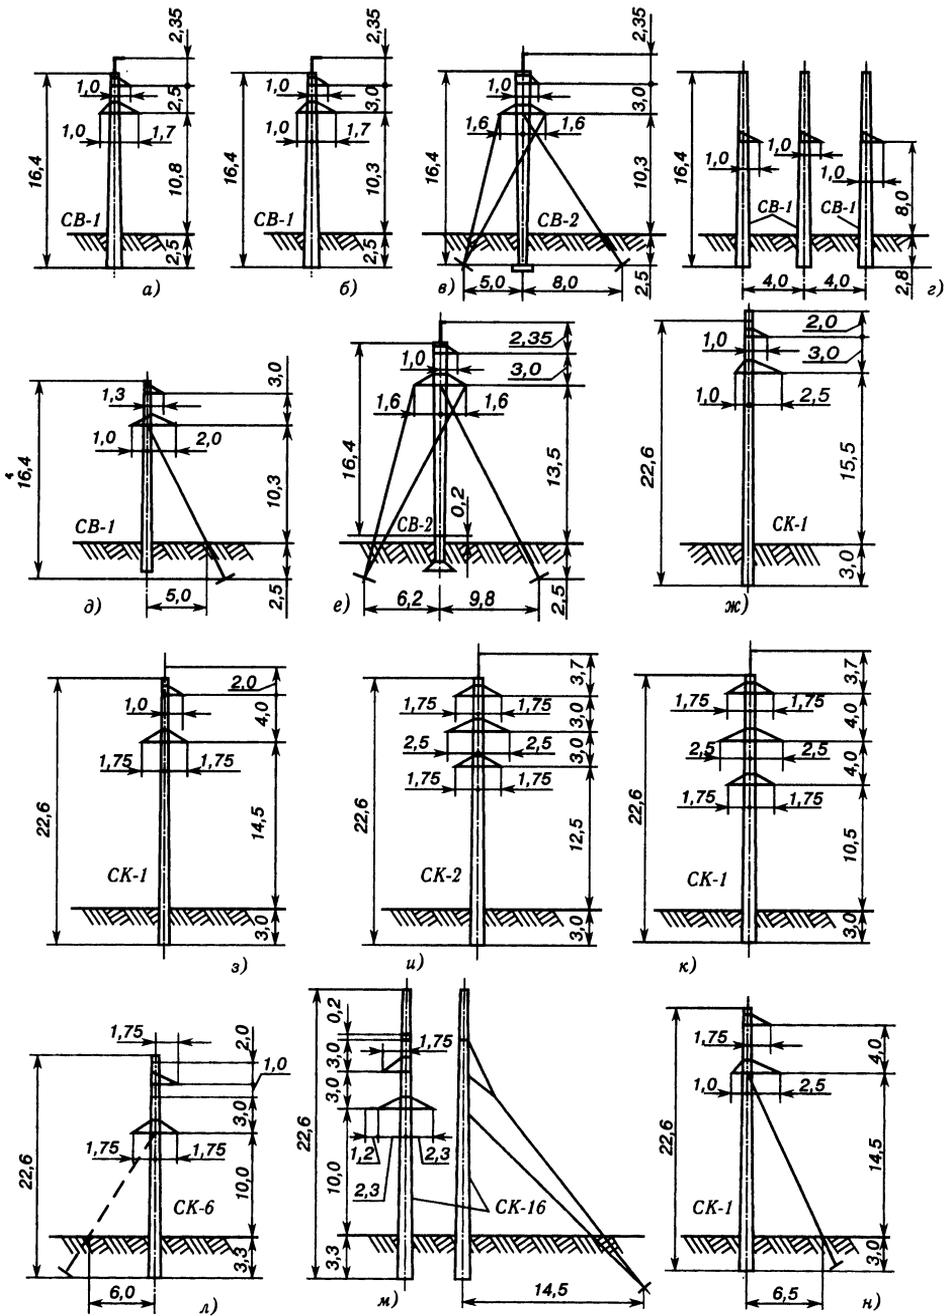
Унифицированные железобетонные опоры ВЛ 35 кВ
